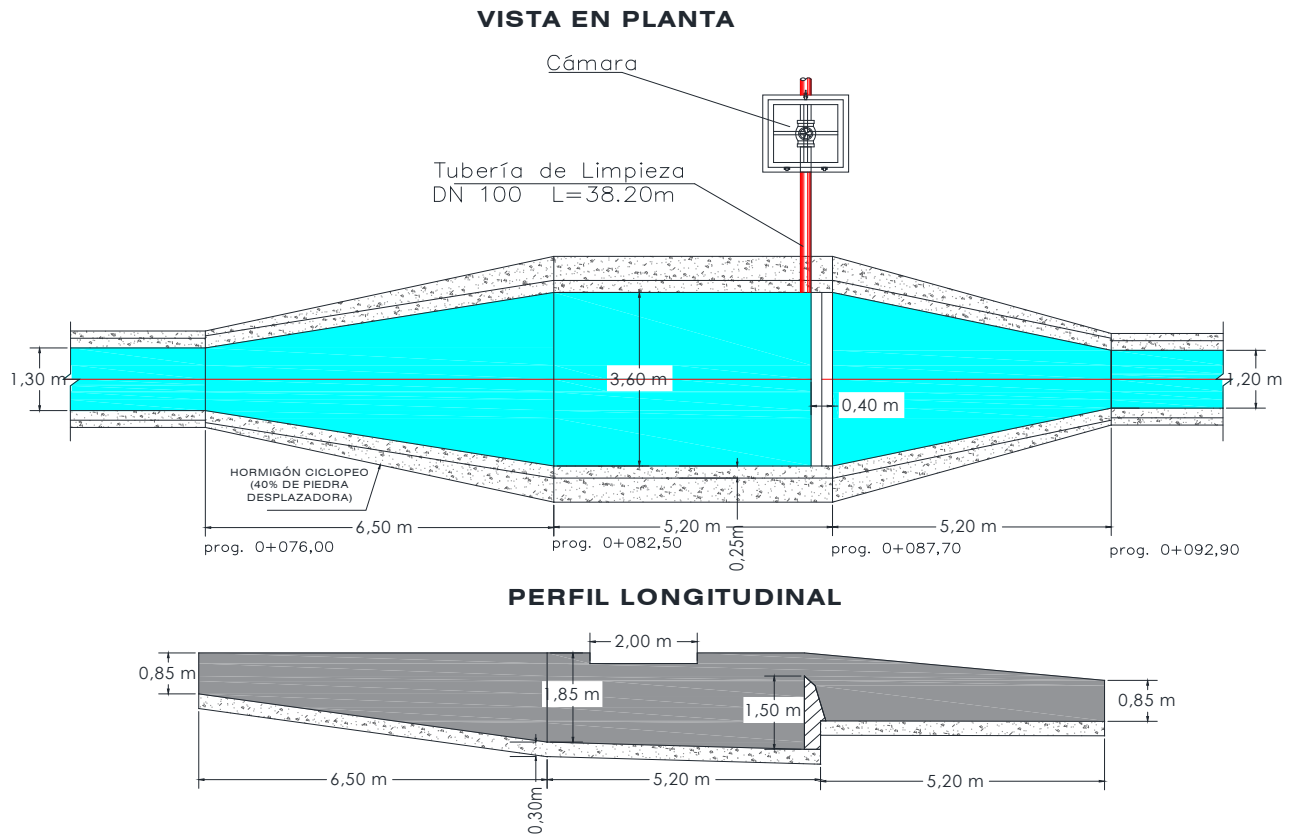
Desarenador progresiva 0+076 vista en planta y corte.
